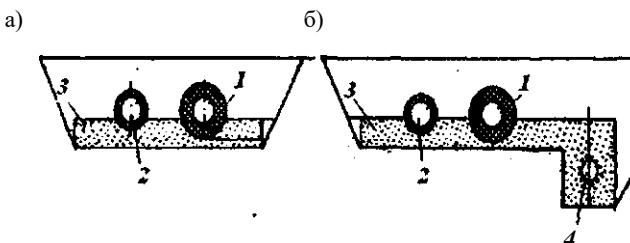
Бесканальная прокладка теплопроводов: а - в грунтах сухих; б - то же, в мокрых; 1 - трубопровод подающий; 2 - то же, обратный; 3 - песчаная подготовка; 4 - трубопровод дренажный
